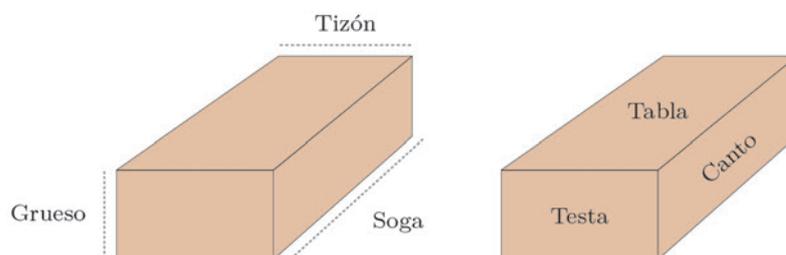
Partes del ladrillo. Fuente: Déleg (2010). Elaboración: Autora.
